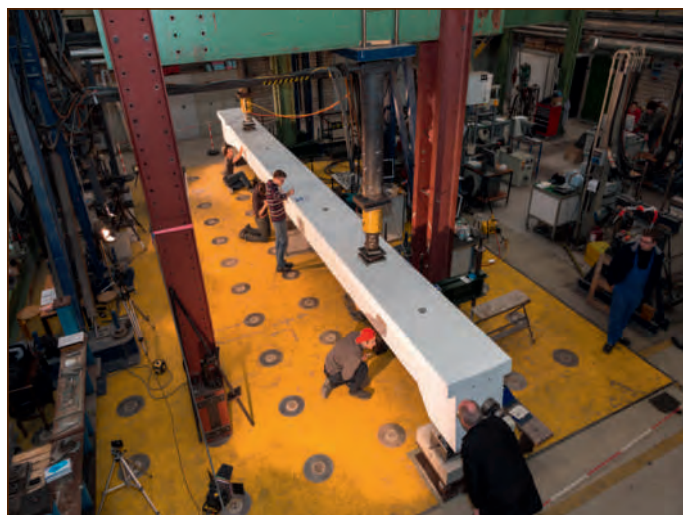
Messungen an vorgespannten Betonträgern, Versuchsaufbau des Lehrstuhls Betonbau (Prof. Reinhard Maurer), Foto: Detlef Podehl
